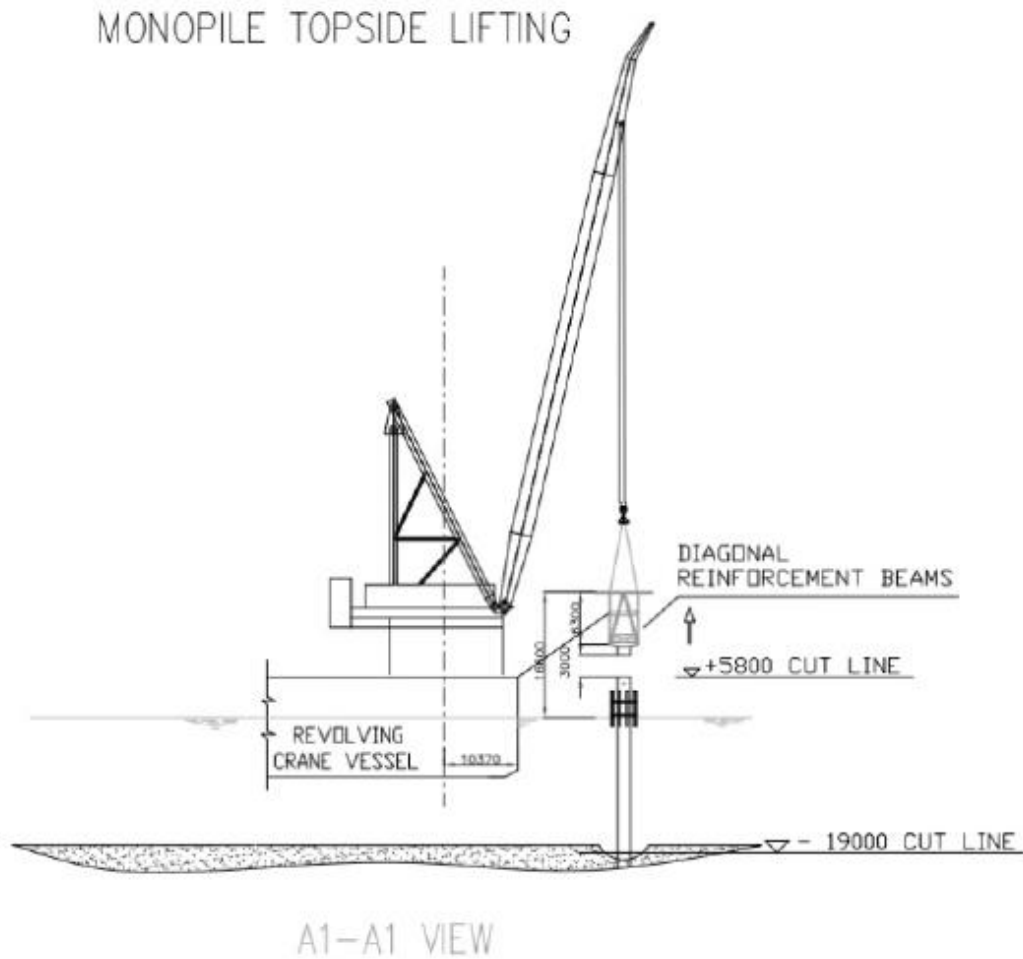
Piattaforma Armida 1 – Sketch di Rimozione Ponte tipico utilizzando Nave Gru a Braccio Mobile
